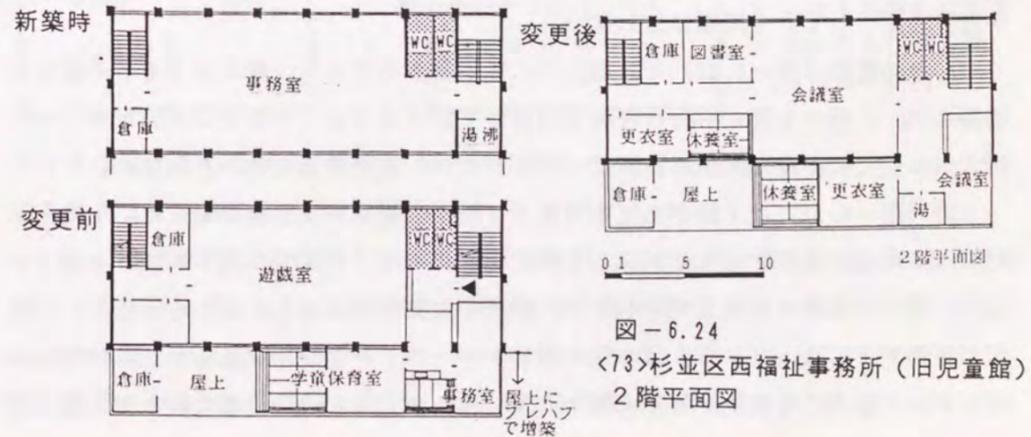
<73>杉並区西福祉事務所（旧児童館）2階平面図
